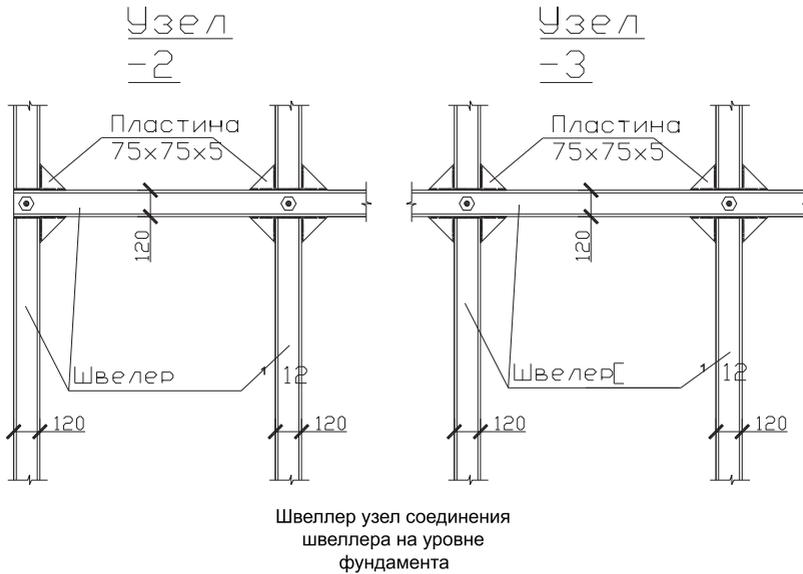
Схема усиления одноэтажного здания с продольными несущими стенами с использованием металлопроката
